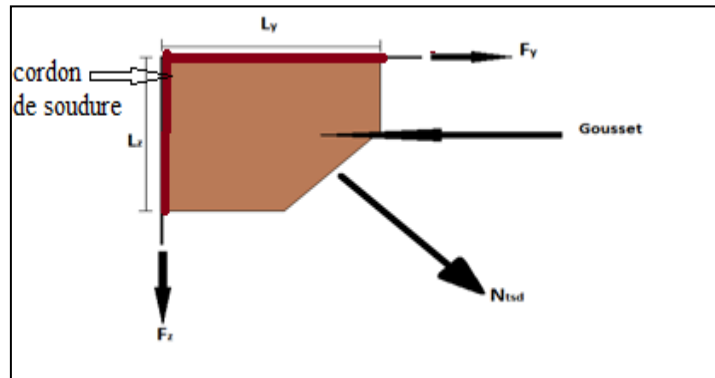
Assemblage gousset nœud du portique par cordon de soudure.
